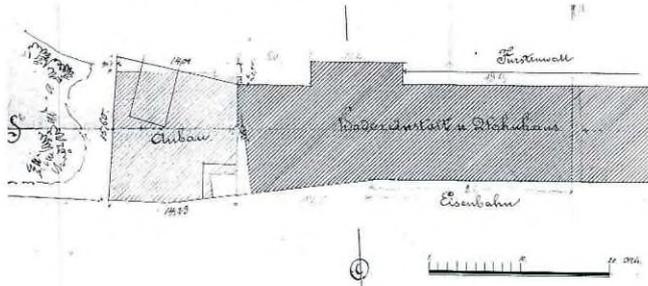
Lageplan des Grundstücks Fürstenwall 3a mit dem Anbau des Wohnhauses südlich der ehemaligen Badeanstalt, z.T. über dem ehemaligen Rondell. Bauaktenkammer des StA Magdeburg. Fürstenwall 3a. 1886.
